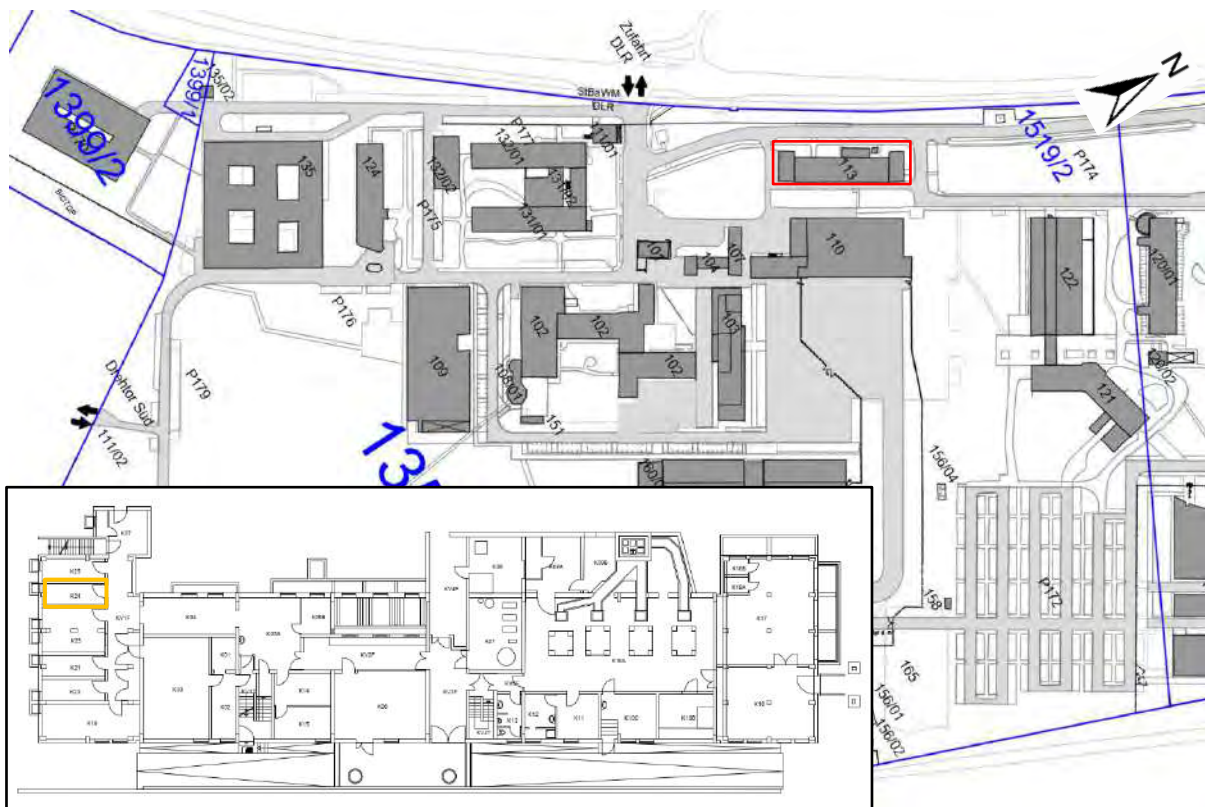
Lage von Gebäude 113 (rot). Ausschnitt aus [6]. Im Kellergeschoss-Grundriss Lage der KVF als orangene Markierung [23].
